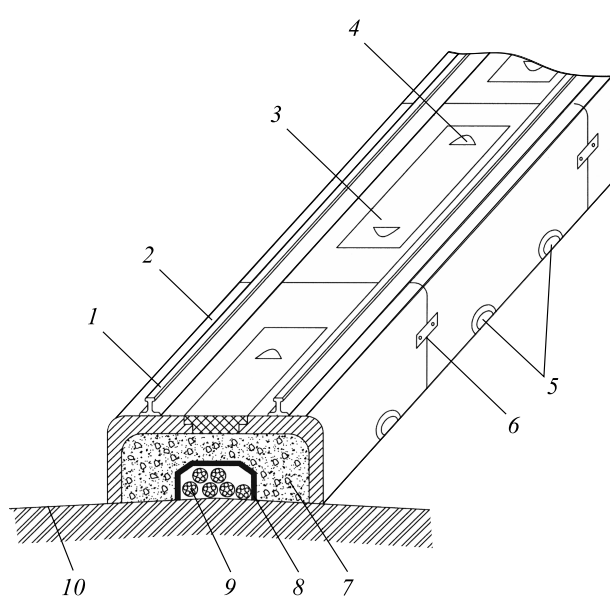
Предлагаемое дорожное покрытие (толщина дорожного полотна не превышает действующий размер): 1 — рельс; 2 — короб; 3 — крышка; 4 — скоба на шарнирах; 5 — дренажные отверстия; 6 — соединительное звено для коробов; 7 — щебень или гравий (обеспечивает ровность поверхности за счет регулярной подготовки); 8 — кожух для линий связи и энергетики; 9 — кабель (провод); 10 — земляное полотно
